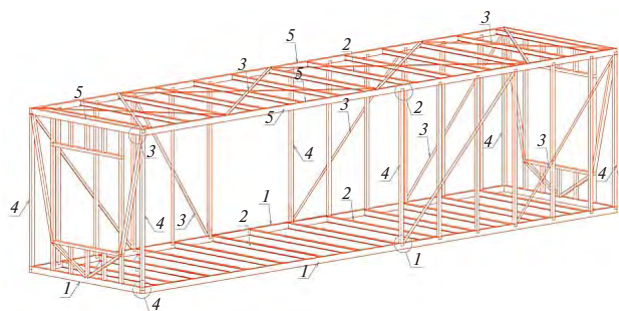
Схема основных элементов каркаса модулей: 1 – основные несущие балки основания блок-модуля (продольная, поперечная) выполняются из профилированной трубы прямоугольного сечения, ходовое сечение 200×100 мм, толщина стенки подбирается по расчету; 2 – поперечные второстепенные балки основания-пола модуля и перекрытия модуля выполняются из профилированного двутавра № 14–16, ходовой шаг 50–60 см. Шаг, номер двутавра подбираются по расчету в зависимости от нагрузки на полы; 3 – горизонтальные и вертикальные связи модулей для создания пространственной жесткости каркаса выполняются из полосного металла; 4 – вертикальные несущие стойки каркаса выполняются из профилированной трубы квадратного и прямоугольного сечений; 5 – основные несущие балки перекрытия блок-модуля (продольная, поперечная) выполняются из профилированной трубы прямоугольного сечения
